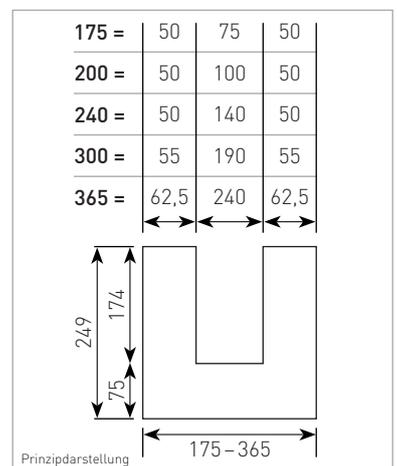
Abmessungen zur Bemessung des Betonkerns bei U-Schale, bewehrt
